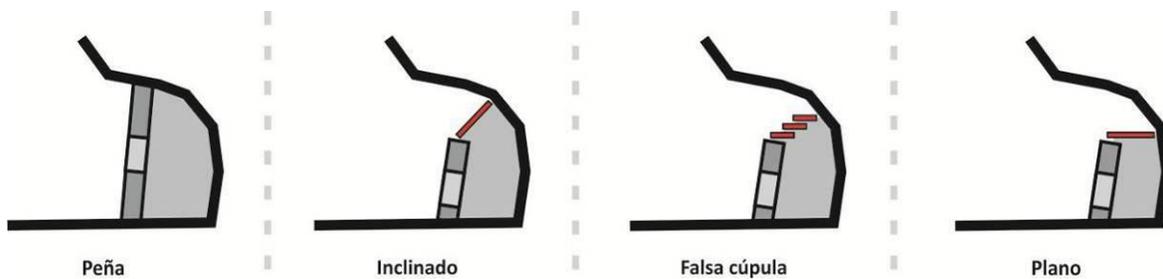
Esquema de las distintas resoluciones de las cubiertas de las estructuras.
